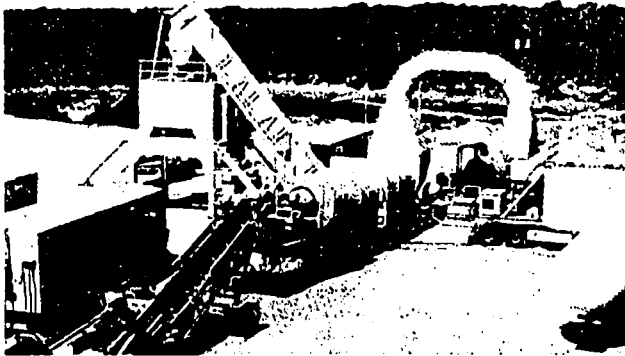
Planta de mezclado en caliente con tambor de secado.
